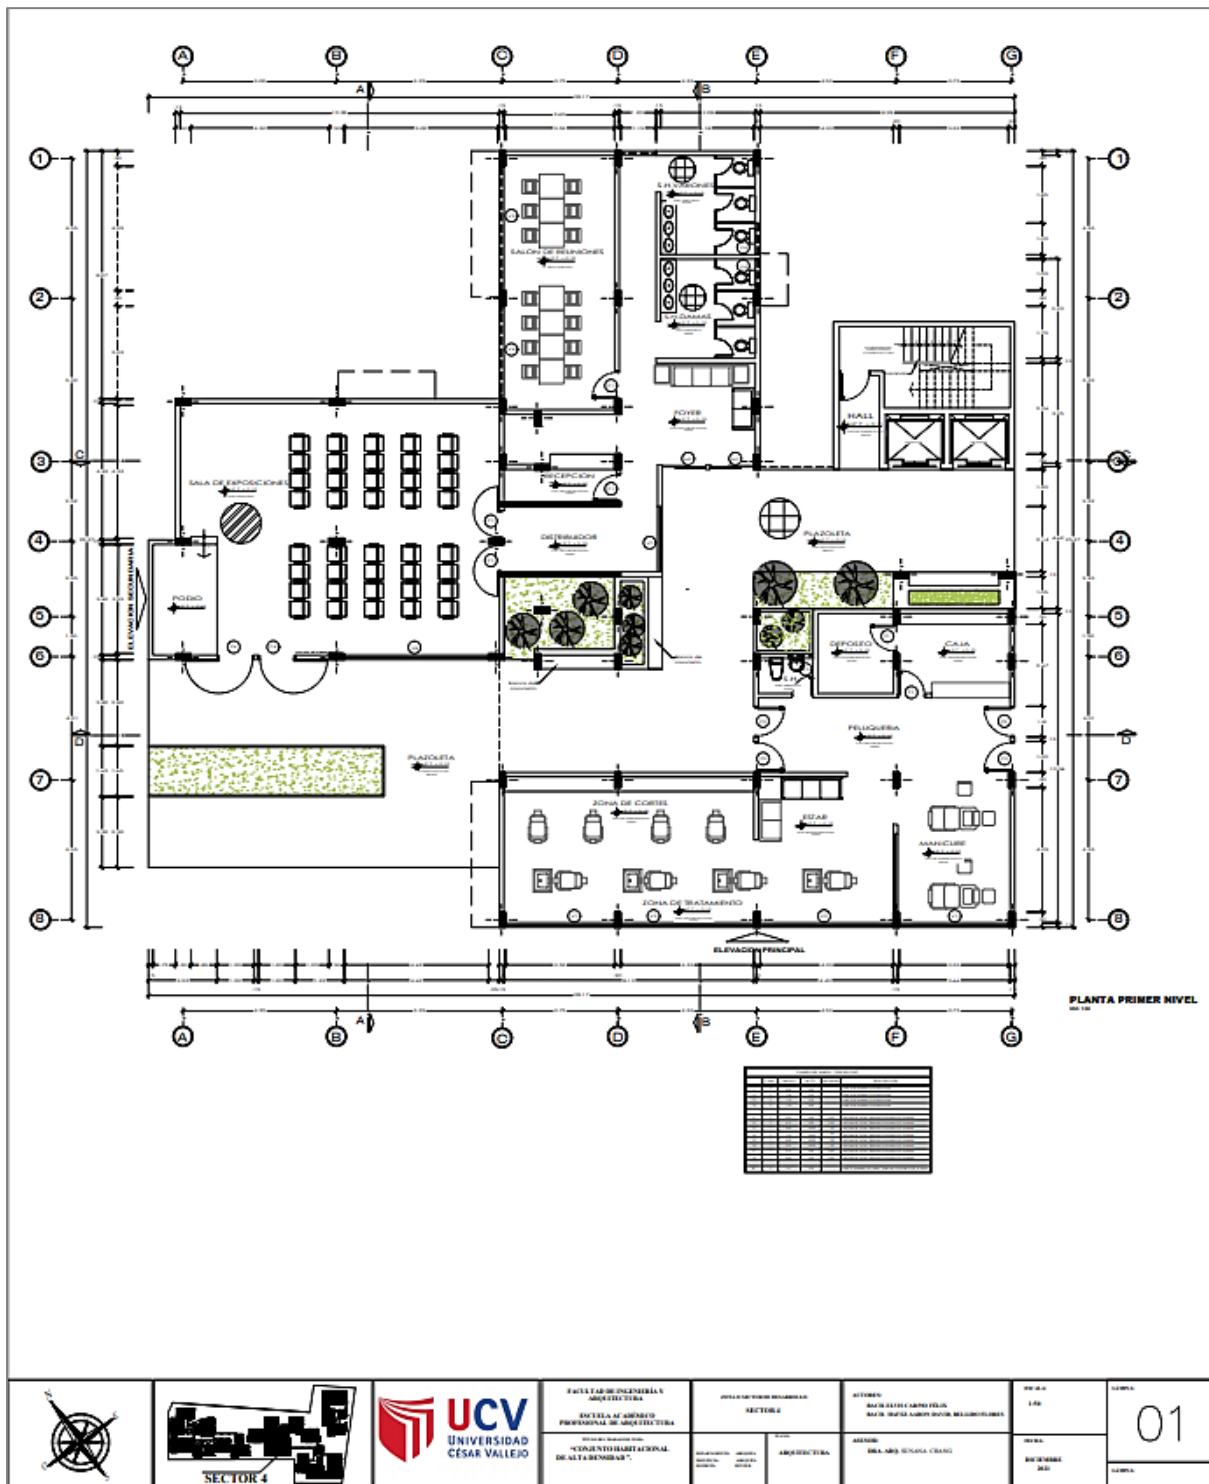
Planos de Arquitectura – 01 - Bloque 4 – Primer Nivel
